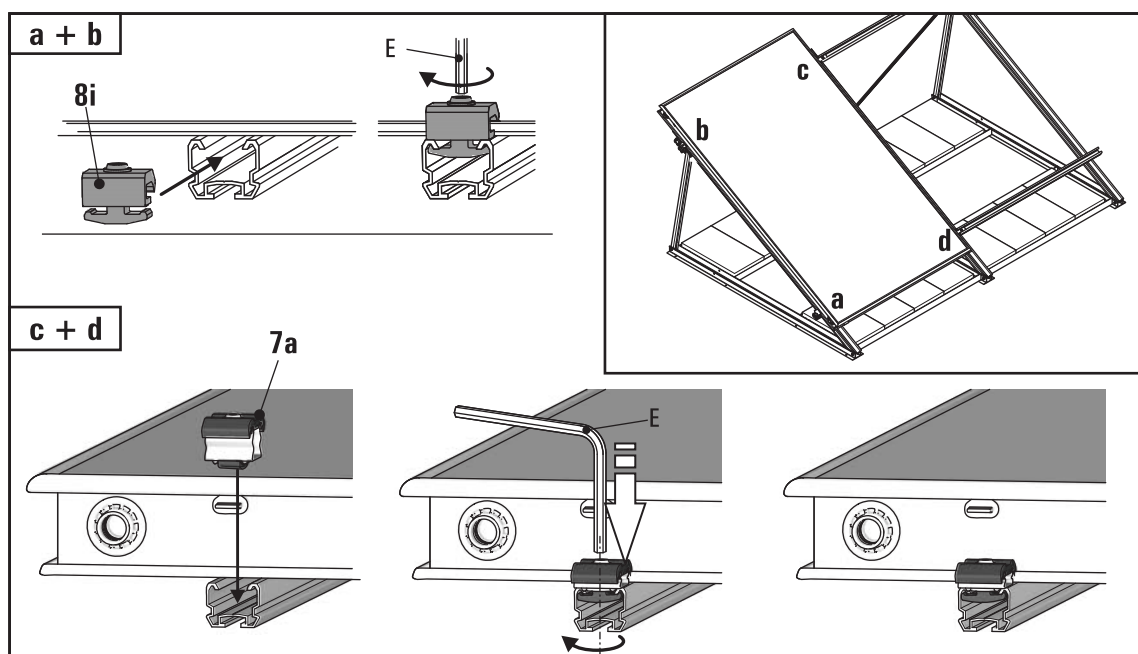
Vissez le capteur plan au moyen des coulisseaux simples (8i) sur le rail de profilé de montage et mettez en place des coulisseaux doubles (7a).
